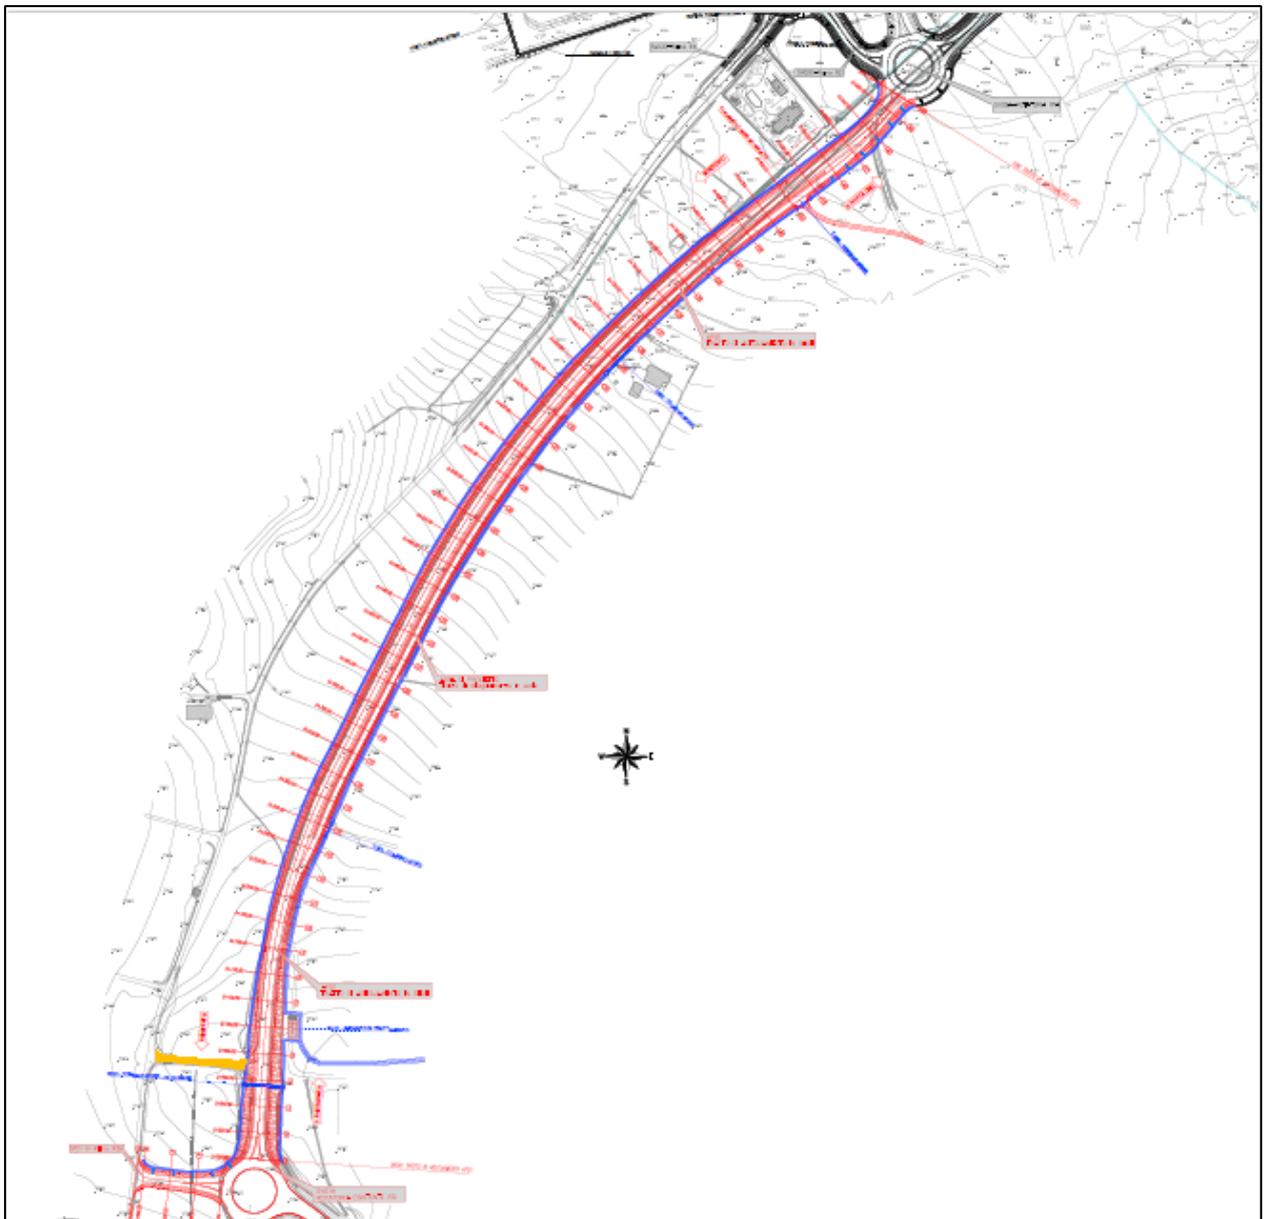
Planimetria di progetto Tratto di adeguamento in sede
